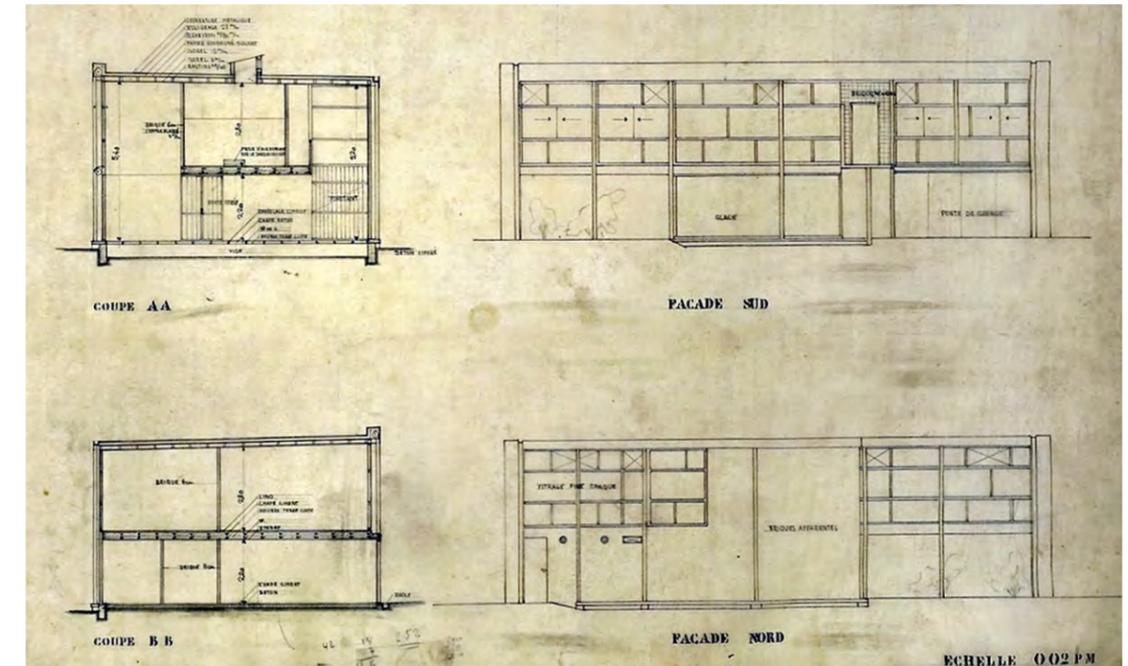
FLC 18558: Vivienda para el doctor Rameaux. Primer proyecto. Secciones y alzados.
